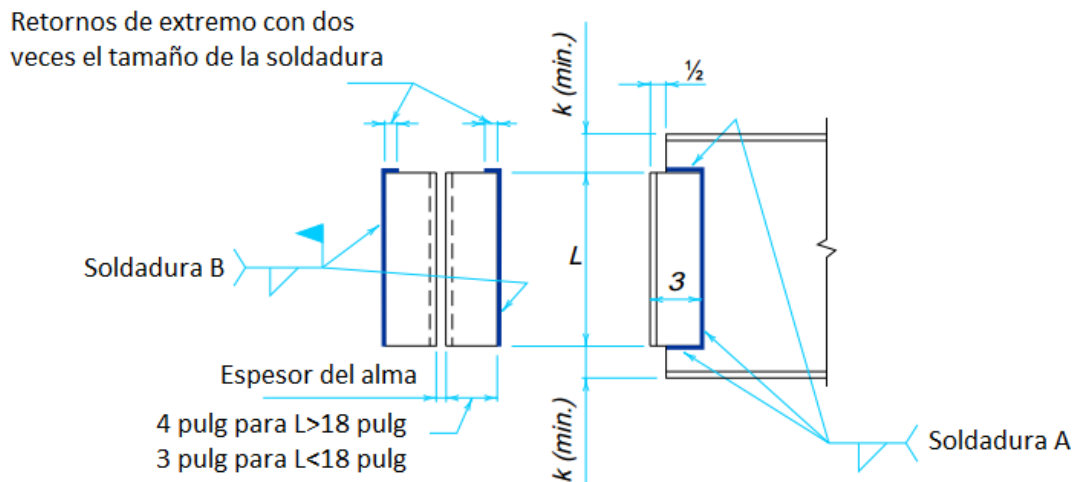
ESQUEMA DE SOLDADURAS A Y B
